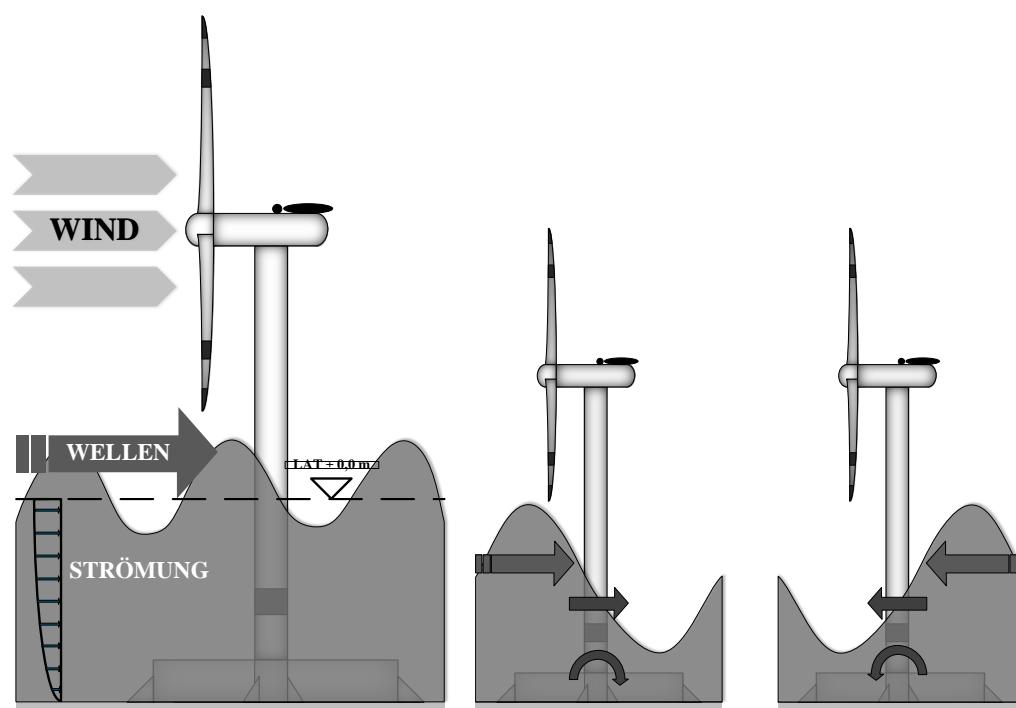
Belastung des Betonfundamentes einer Offshore-Windenergieanlage nach [1]
